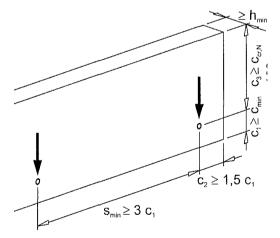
Einbausituation Wandfläche - Querbeanspruchung, ohne Rückhängebewehrung
